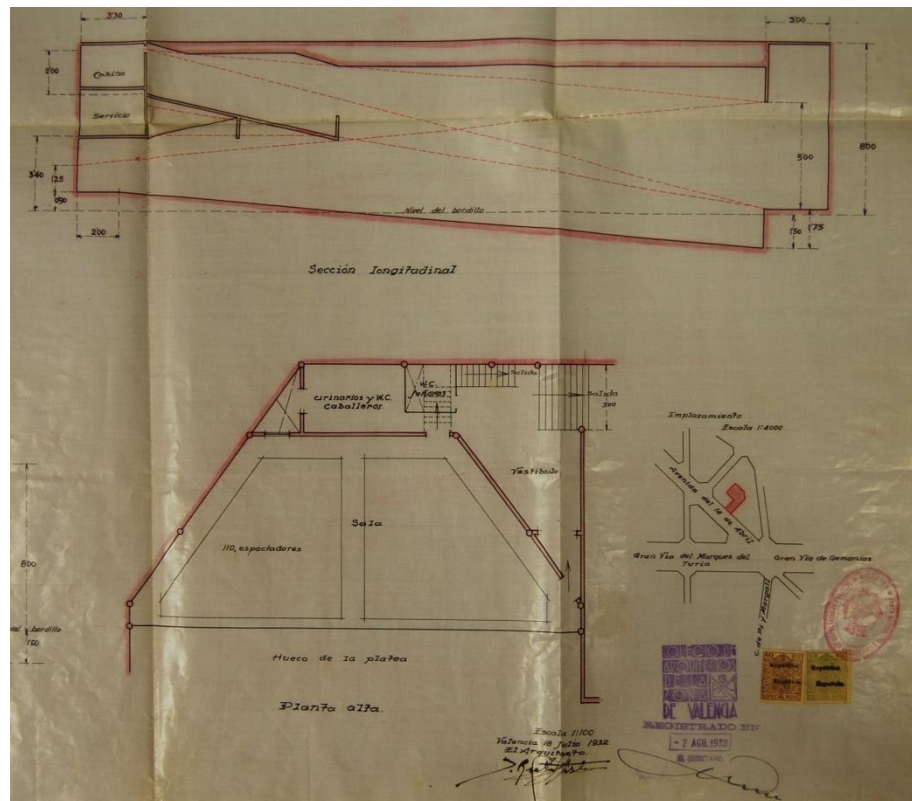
Lámina que incluye la sección longitudinal y el plano de la planta alta del cine Tyrus
